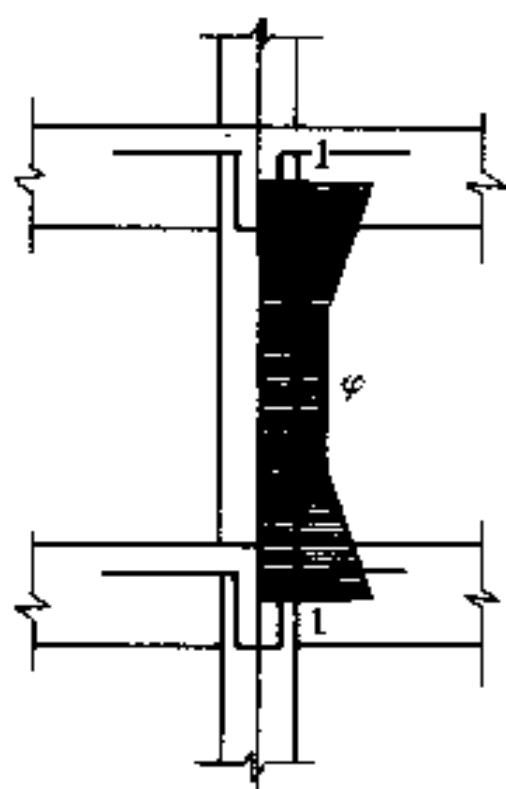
钢筋混凝土轴压构件稳定系数 φ
